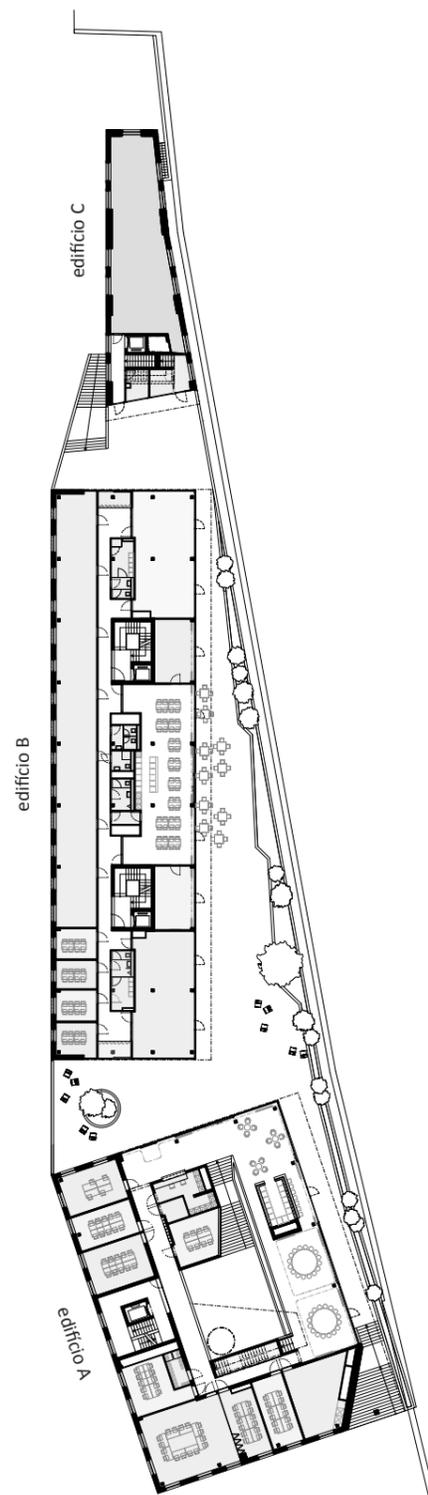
Planta do 1º pavimento do complexo de Zollhaus
